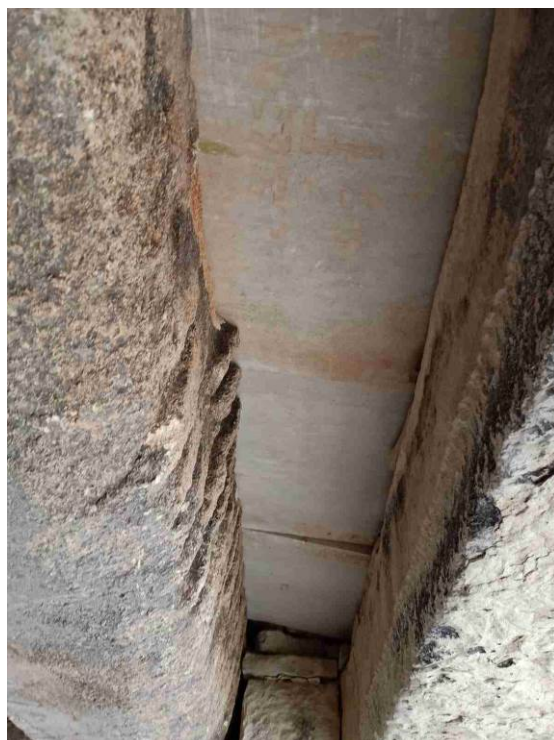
Detalle de las losas colocadas entre vigas, desde el interior del refugio.
